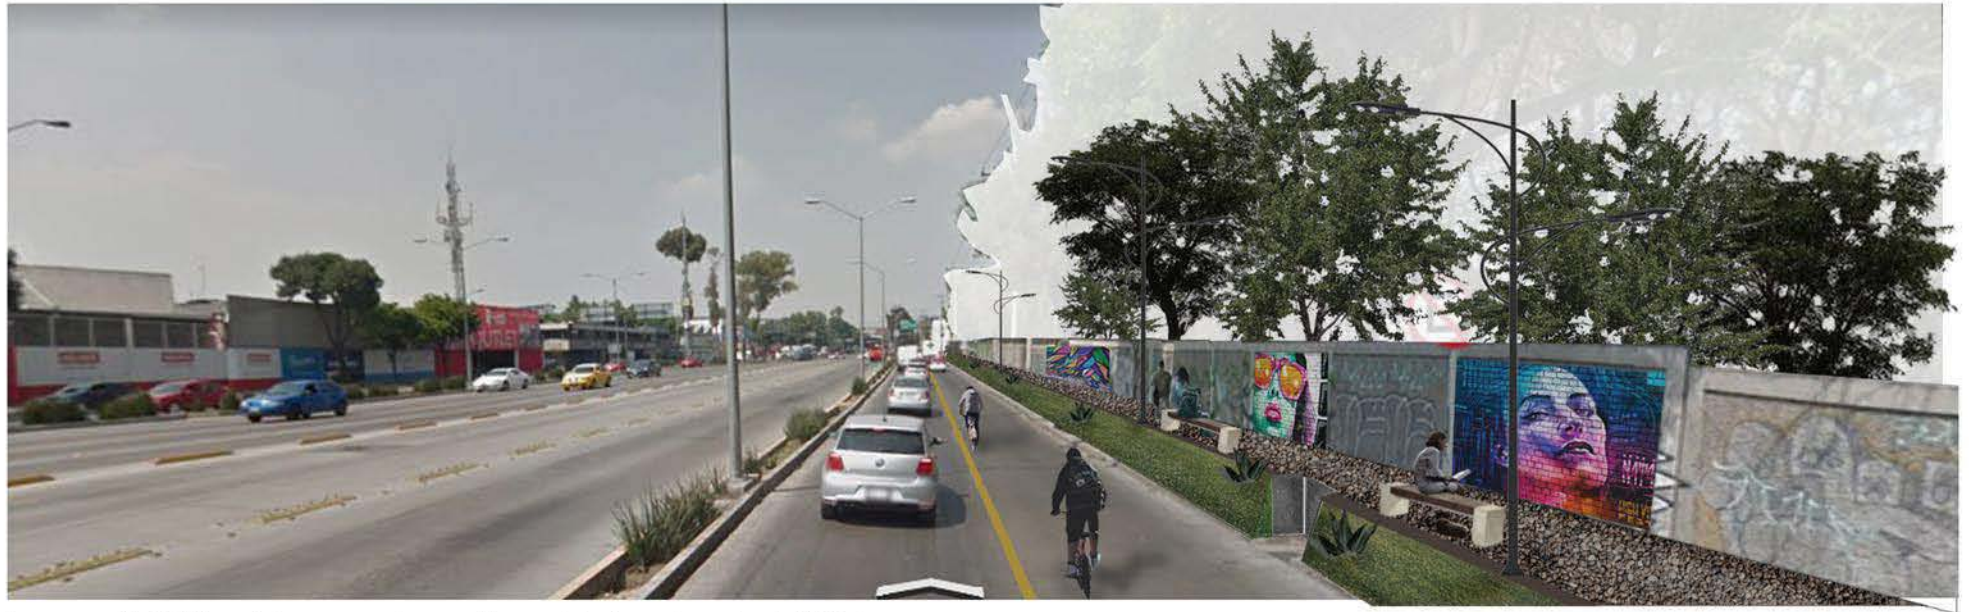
Visión a futuro para banquetas y ciclovía en la calzada Vallejo.
